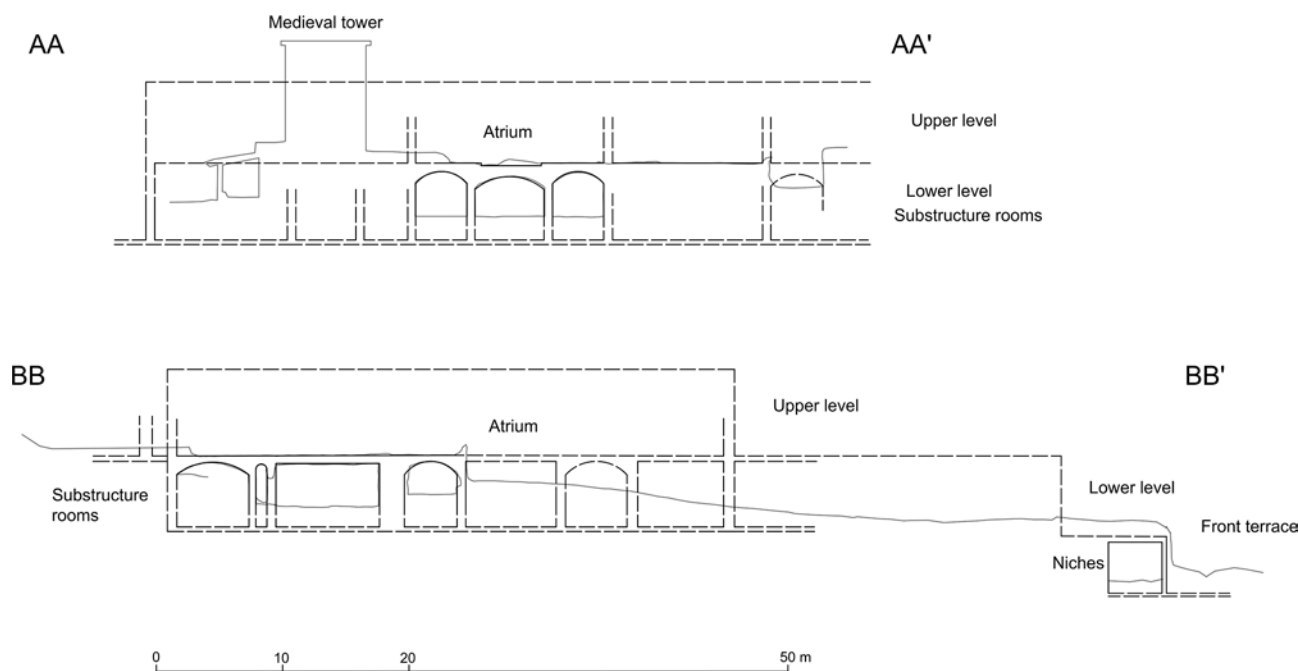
Ricostruzione planimetrica ipotetica degli elevati dell'impianto (da BLANCO ET AL. 2024).
